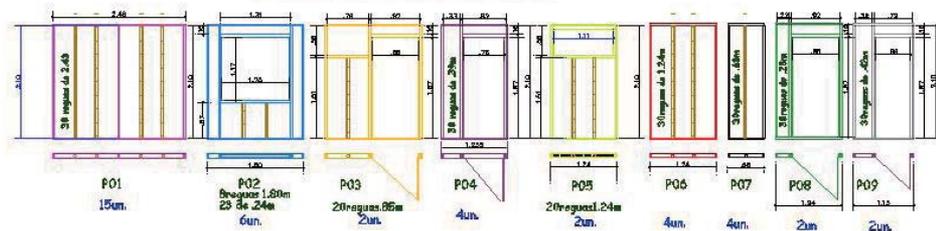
Painéis de parede projetados para o conjunto de 2 casas geminadas da VilaEco.
